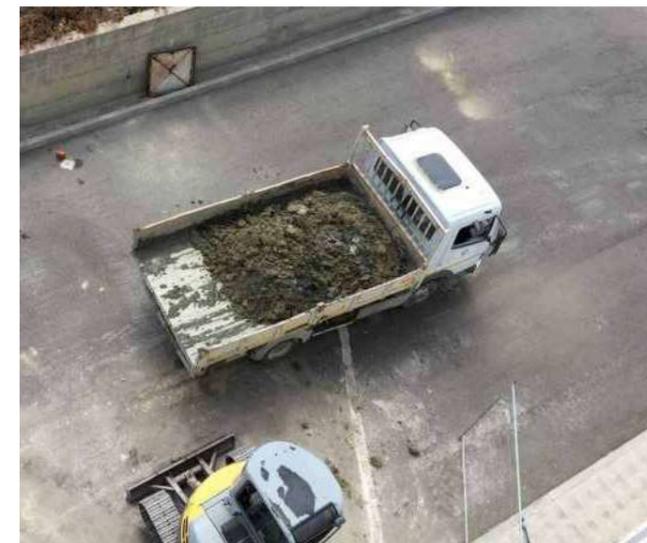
Vista dall'alto delle fasi di asportazione del terreno, di natura argillosa, ove era collocata la riserva idrica (anno 2017)
